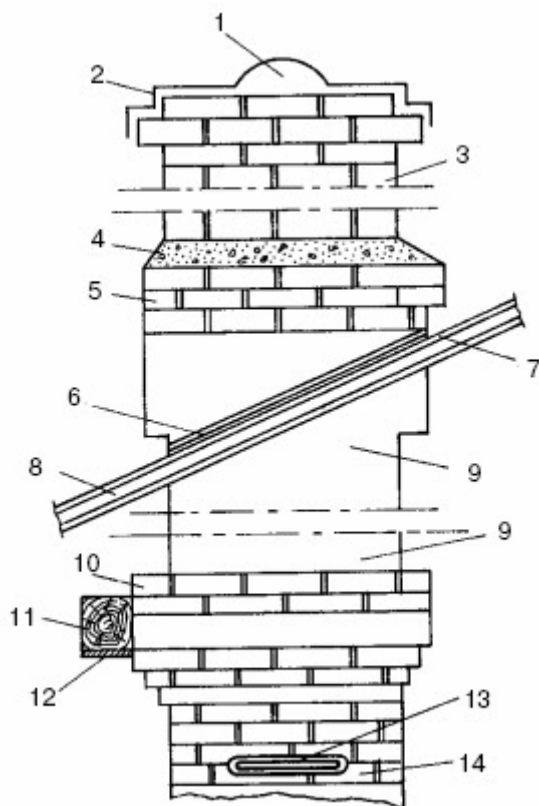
Надсадная дымовая труба: 1 – металлический колпак; 2 – оголовок трубы; 3 – шейка трубы; 4 – цементный раствор; 5 – выдра; 6 – кровля; 7 – обрешетка; 8 – стропила; 9 – стояк трубы; 10 – распушка (разделка); 11 – балка с перекрытием; 12 – изоляция; 13 – дымовая задвижка; 14 – шейка печи
